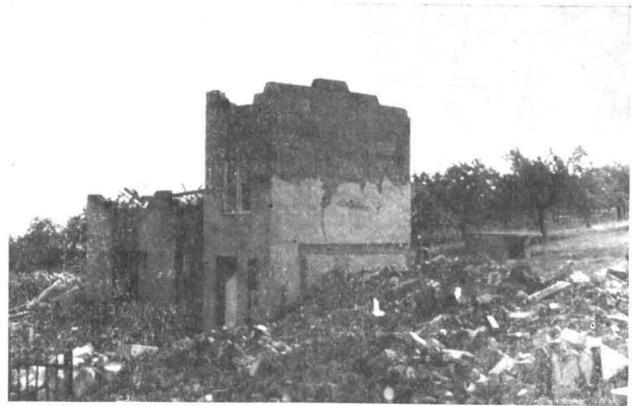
Trümmerhaus mit Massivdecken und deren Schichtungen — Frontansicht
